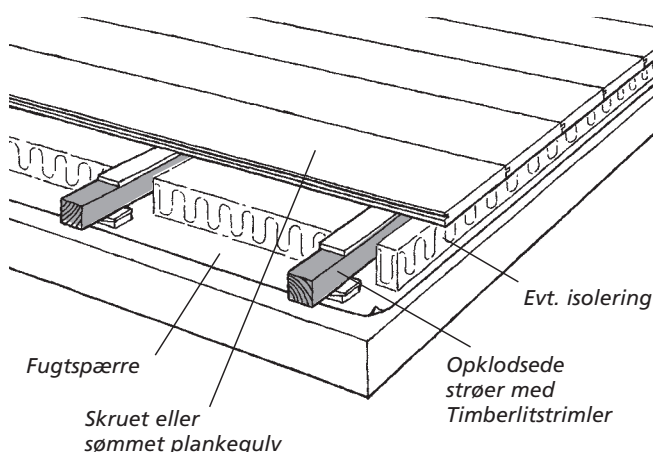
Tegningen viser strøer lagt på beton eller letbeton med afstand ifølge skemaet til højre som underlag for et 22 mm lamelopbygget plankegulv. Der kan isoleres mellem strøerne, såfremt isoleringen over fugtspærren højst udgør 1/3 af den samlede isoleringstykkelse.
